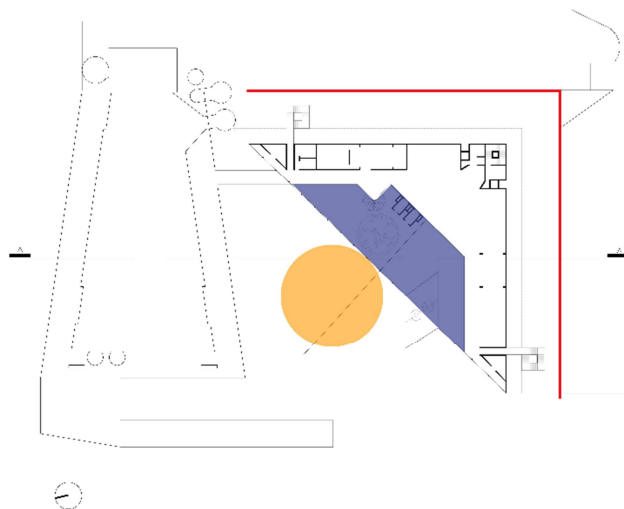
Anexo do Plenário Legislativo em Curitiba: redesenho da planta do pavimento térreo.
